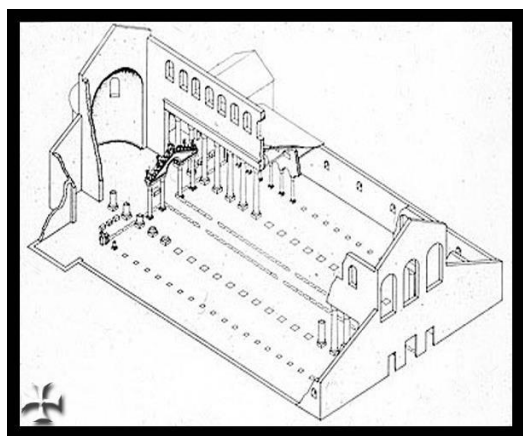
u. 32: San Giovanni in Laterano, Rekonstruktion, (mit durchgehender Kolonnade und Architraven!), Grundriss
